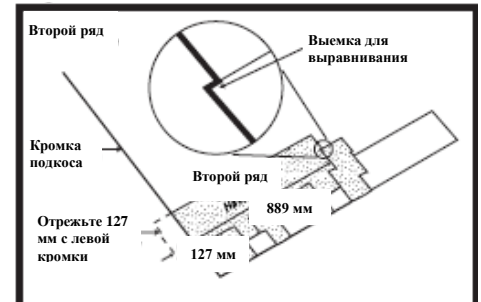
В Схема нанесения кровельных плиток со смещением 127 мм и 381 мм
